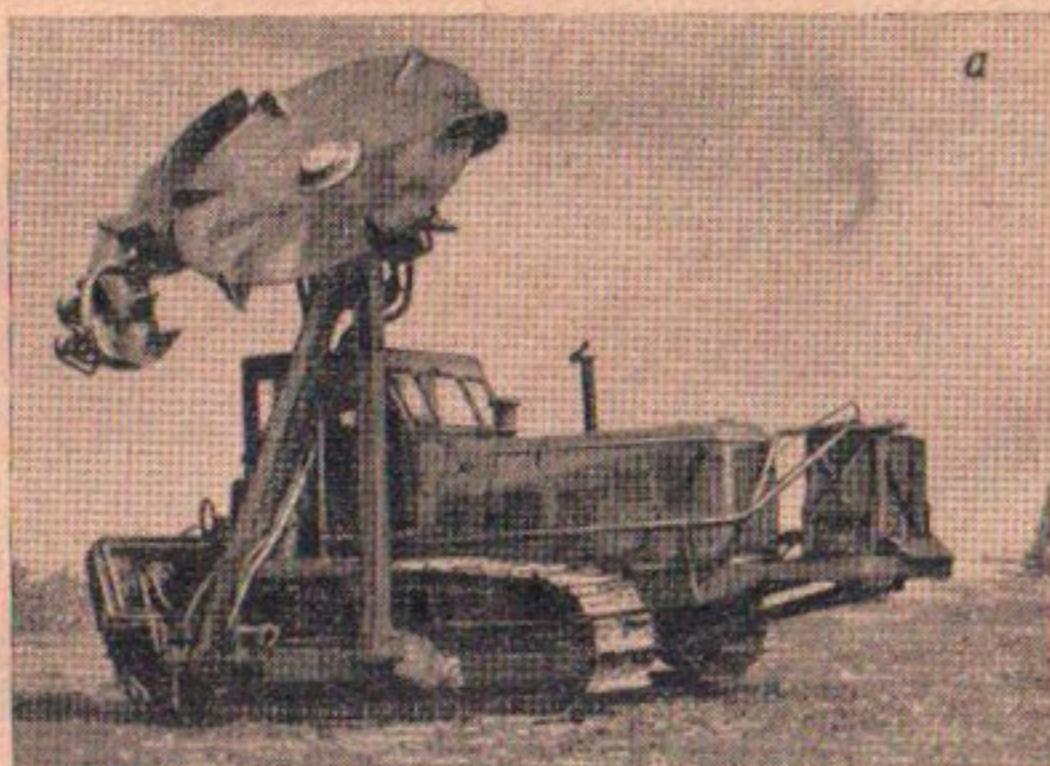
Общий вид каналоочистителя КОБ-1,5
